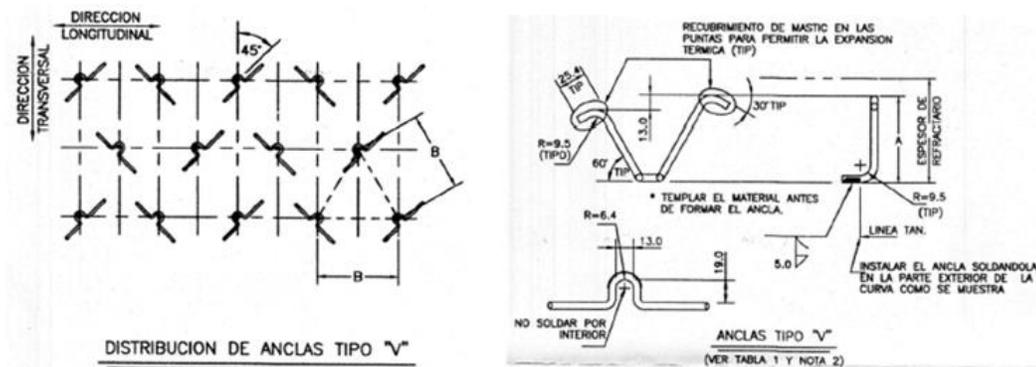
Distribución de anclas en paredes verticales. Fuente: Planos del proyecto.
